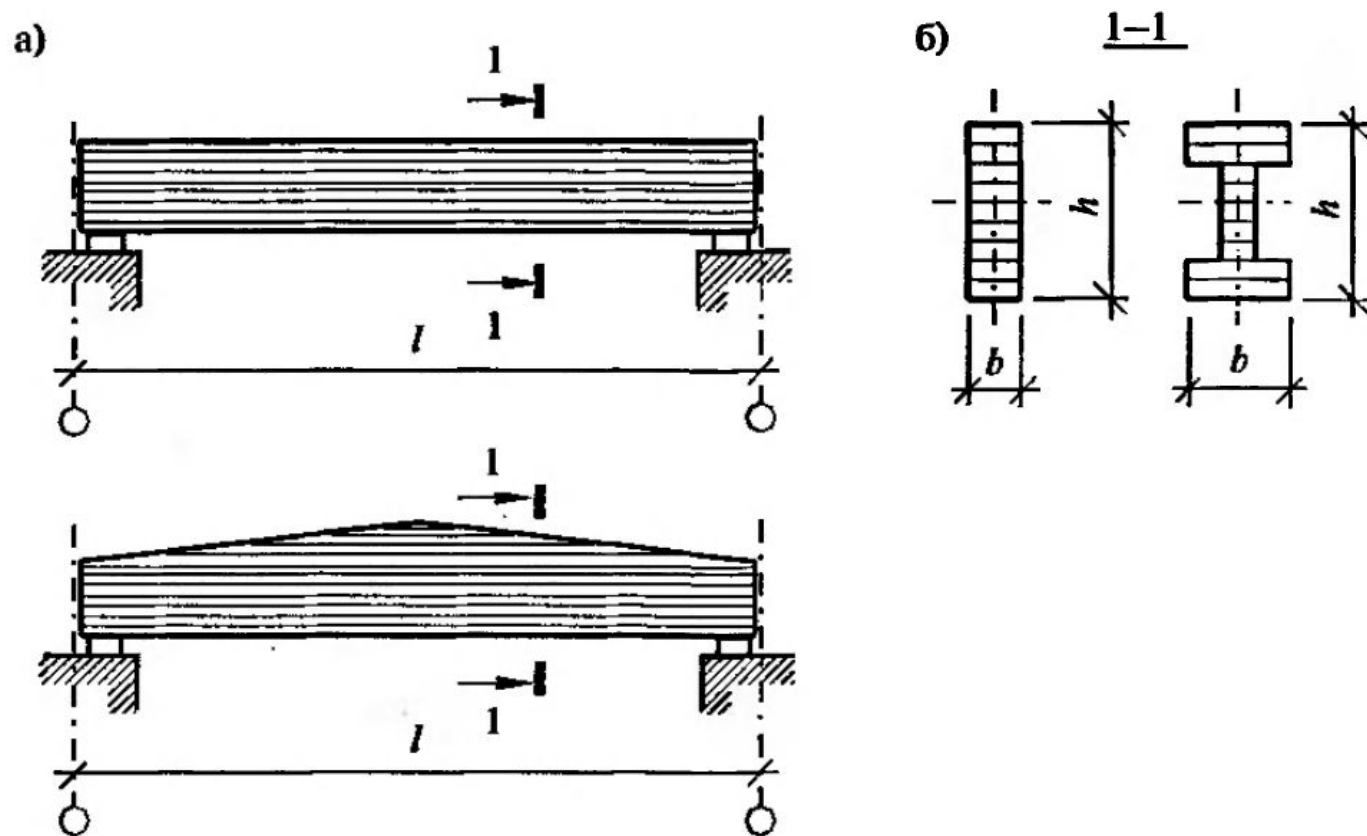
Клееные балки: а) типы клееных балок из досок; б) возможные сечения балок (прямоугольное, двутавровое)
